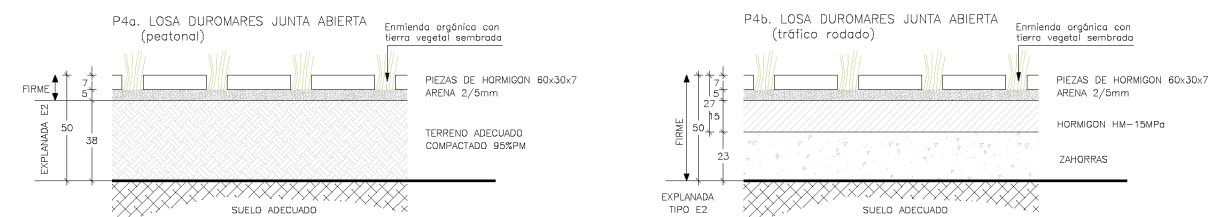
Secciones constructivas del pavimento P4a y P4b.
